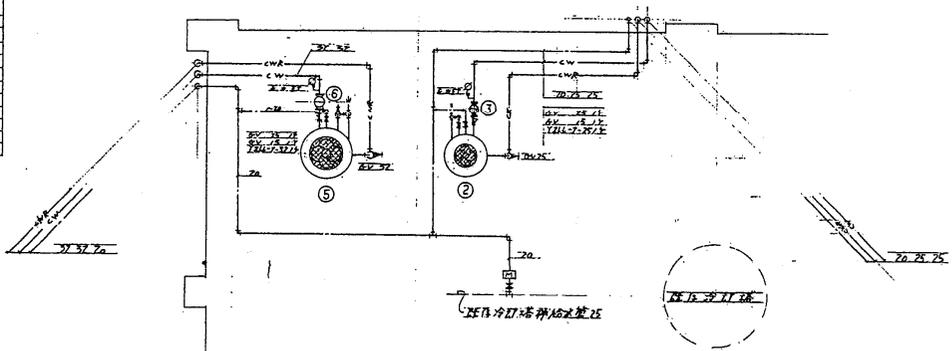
階平面図	工事名	新潟調査設計事務所 建築工事
